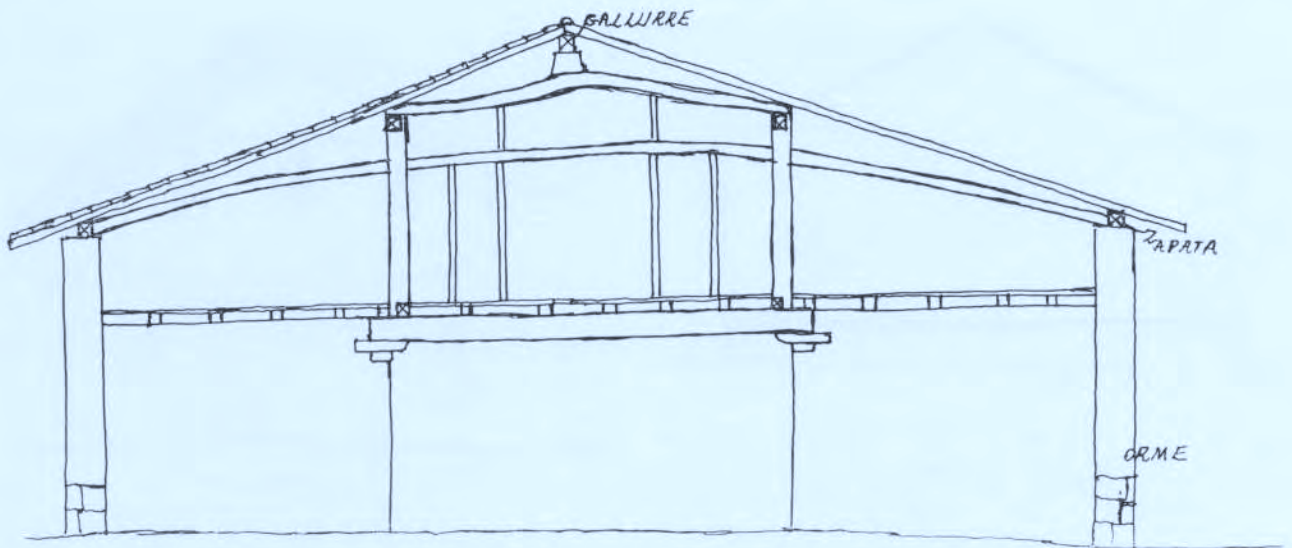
Entramado de la fachada de Sigarrene.
